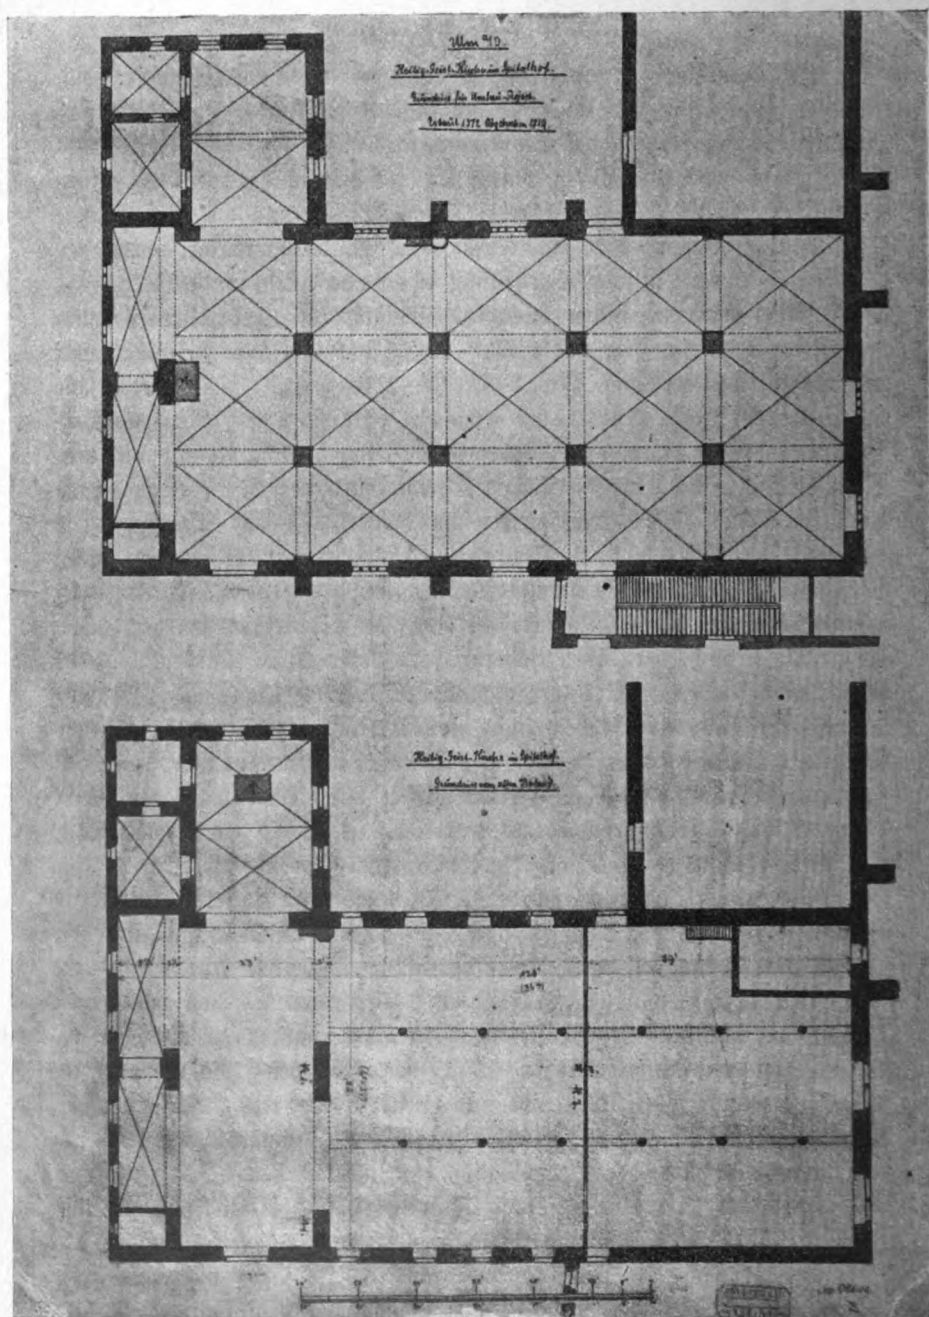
Grundrisse der alten Spitalkirche, unten der wirkliche Bestand, oben der Plan für den Umbau.
